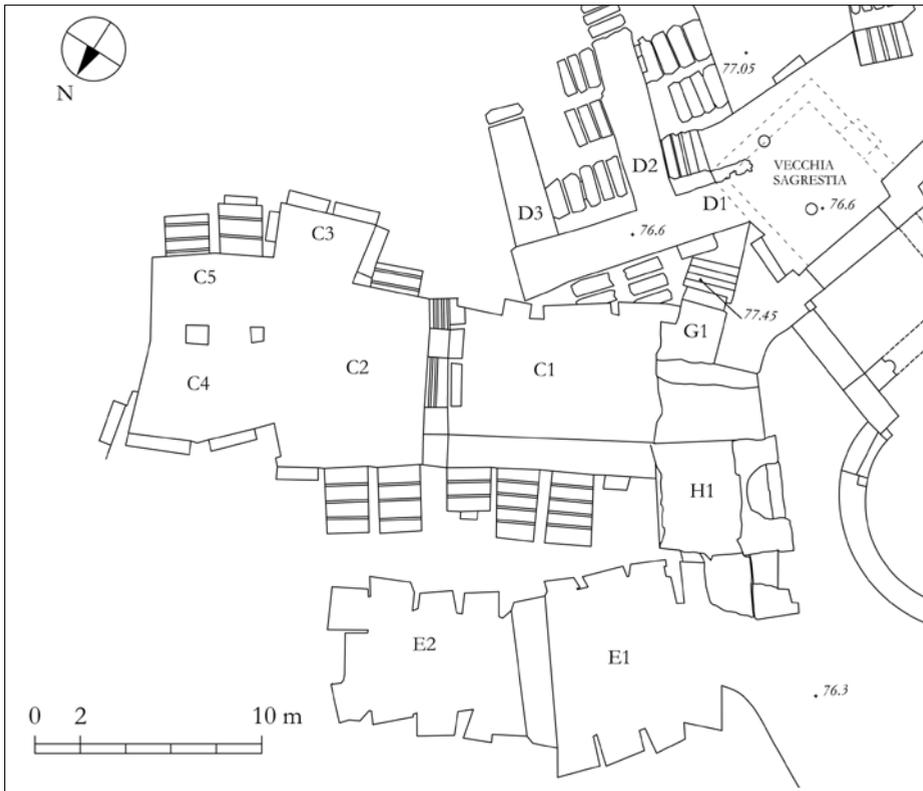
Planimetria dell'area cimiteriale alle spalle della basilica subdiale (da EBANISTA 2010b, fig. 3).
